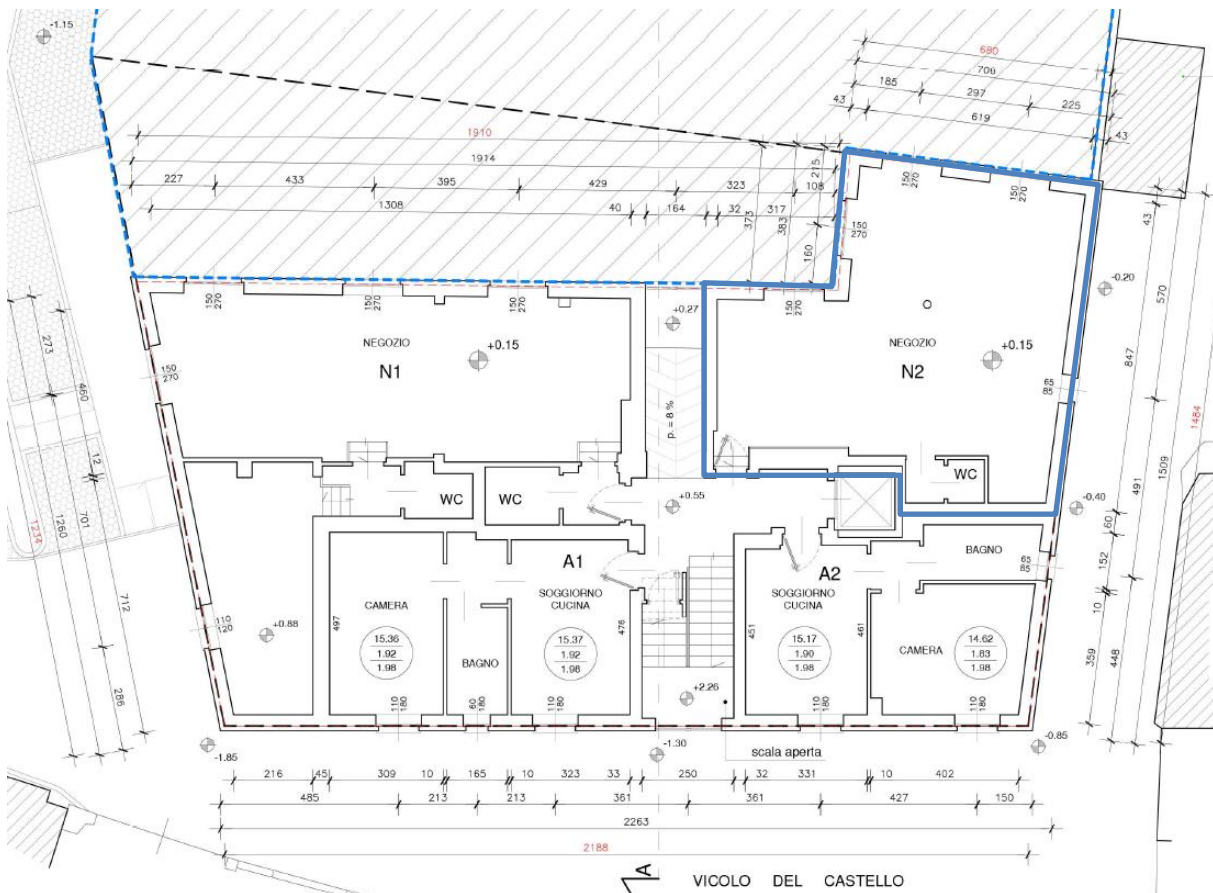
ESTRATTO PIANTA PIANO TERRENO SCIA N. 5709 DEL 2019
